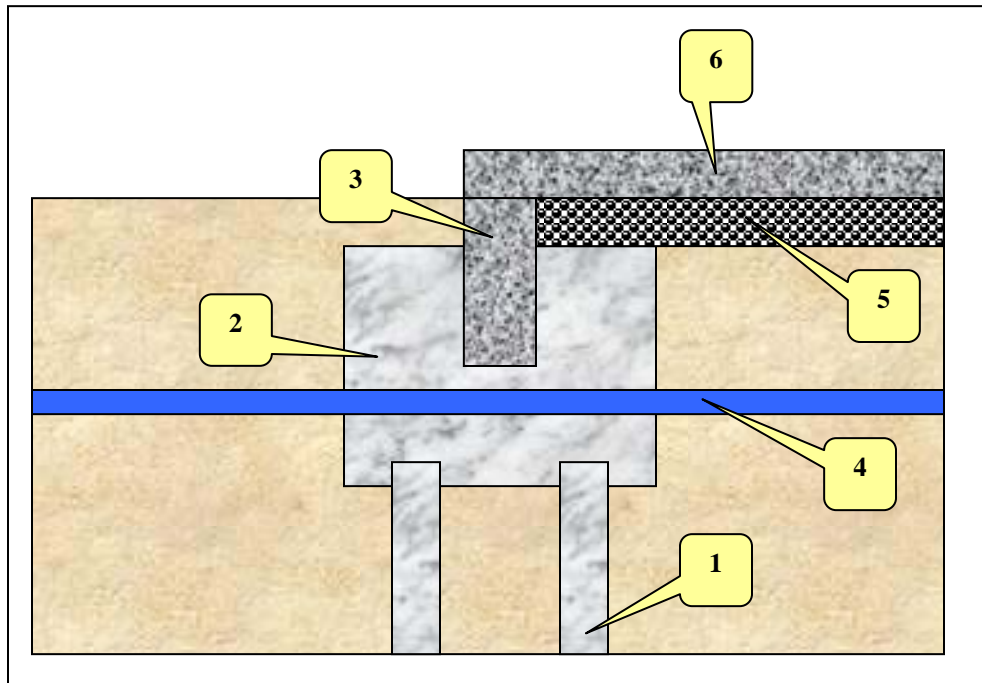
Detalhe da seqüência executiva da implantação de drenos
